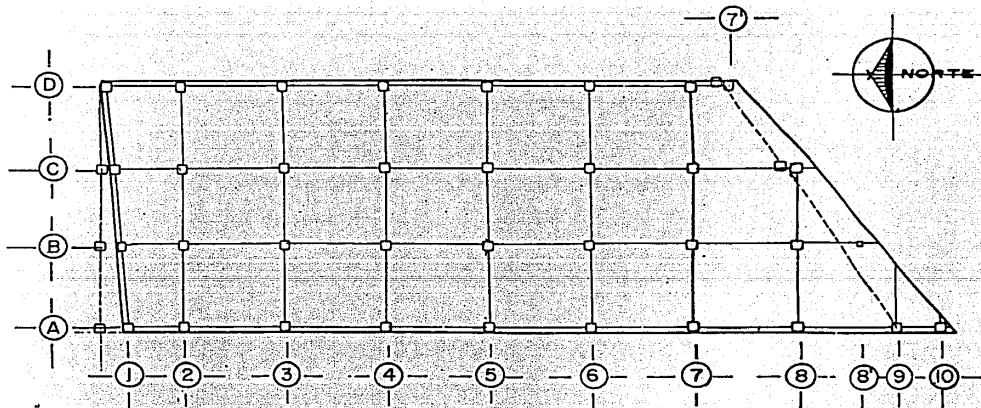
PLANTA DE CIMENTACION ORIGINAL
